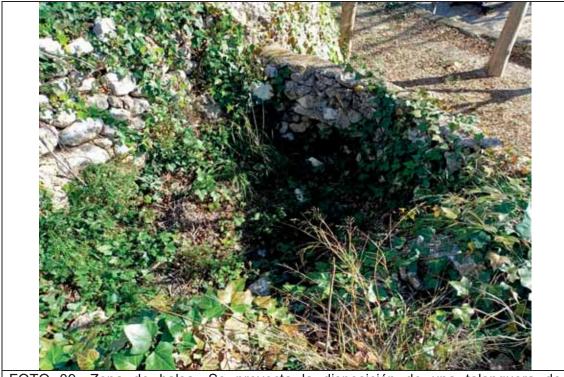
Zona de balsa. Se proyecta la disposición de una talanquera de protección.
